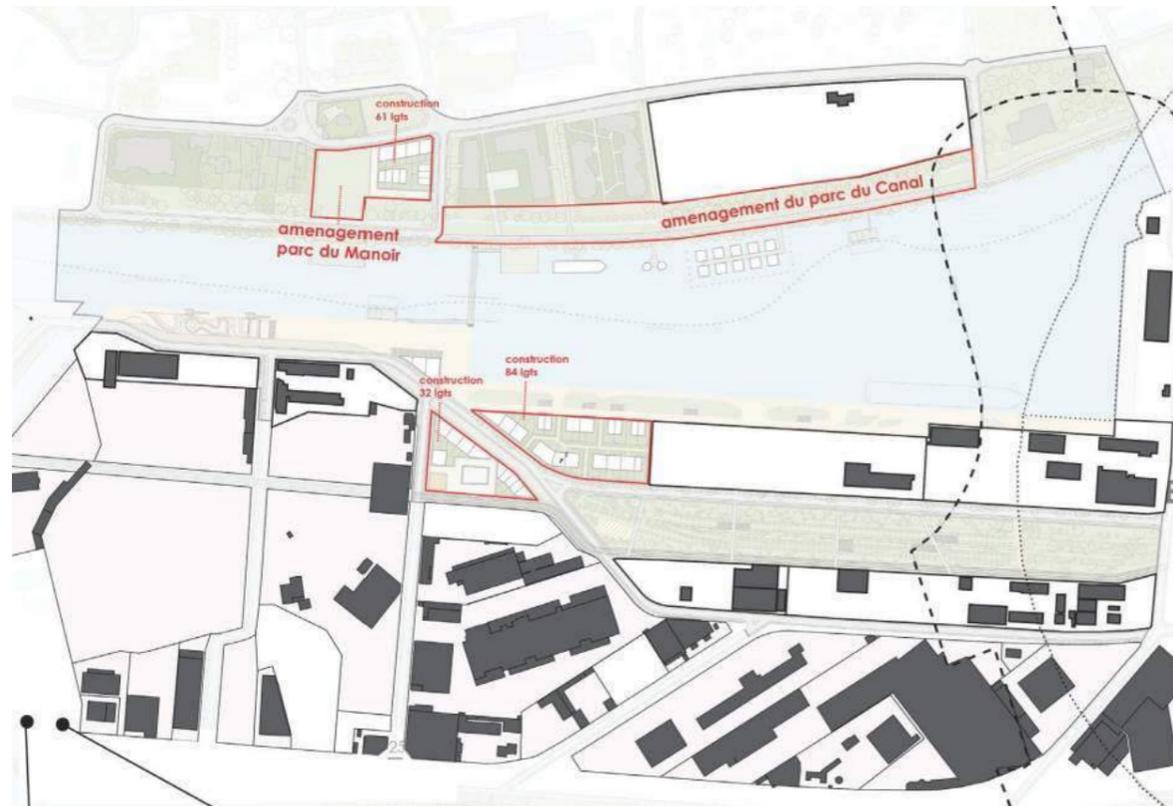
Phase 2 autour du Canal – Site Nouveau Bassin à Caen (source : Plan Guide MVRDV)
